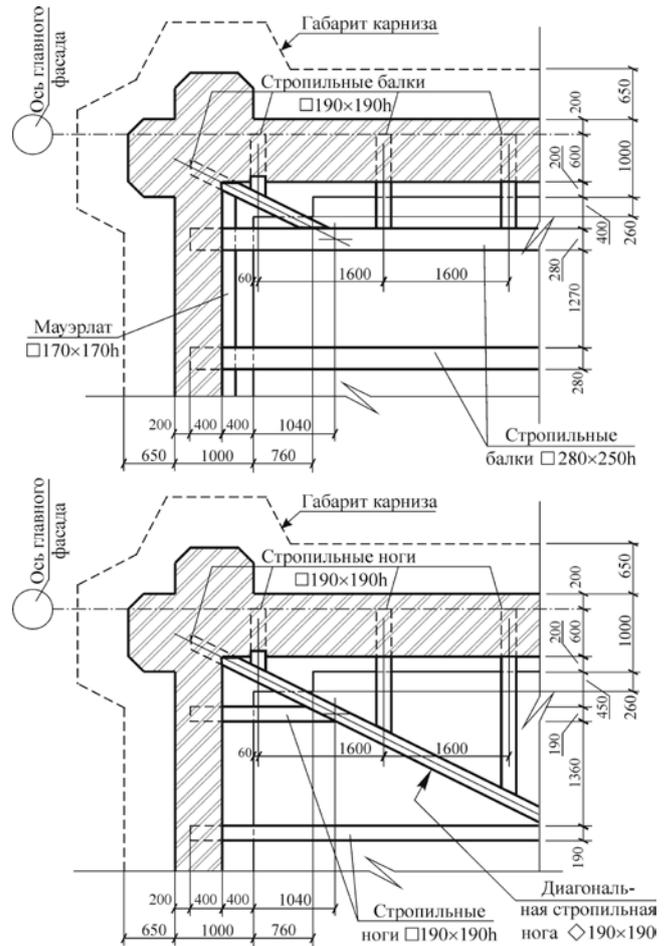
Фрагмент плана стропильной системы на участке постановки статуи: а — в уровне горизонтальных стропильных балок, б — в уровне стропильных ног
